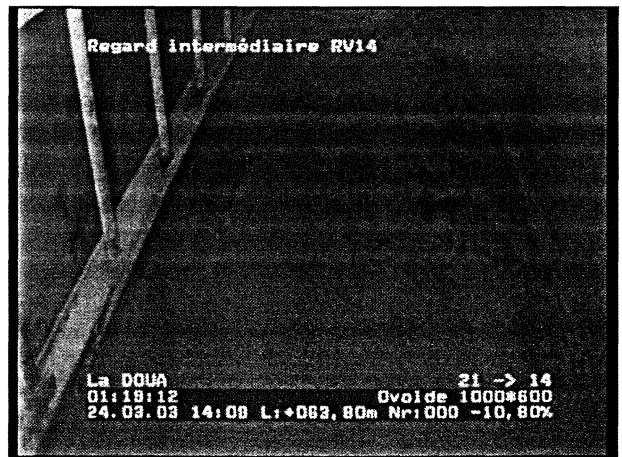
\_5a, N° cassette: 1, 01:19:08
